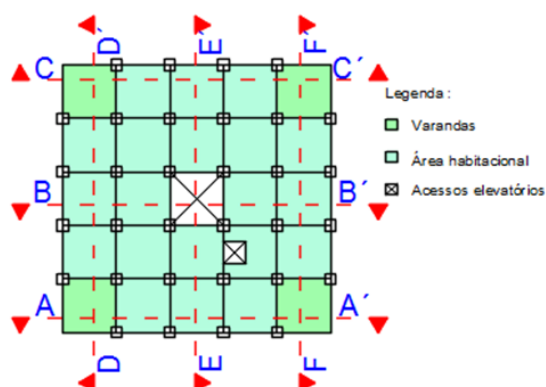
a) Representação esquemática da planta dos pisos 0,1,2,3,4,5,6 e cobertura acessível
